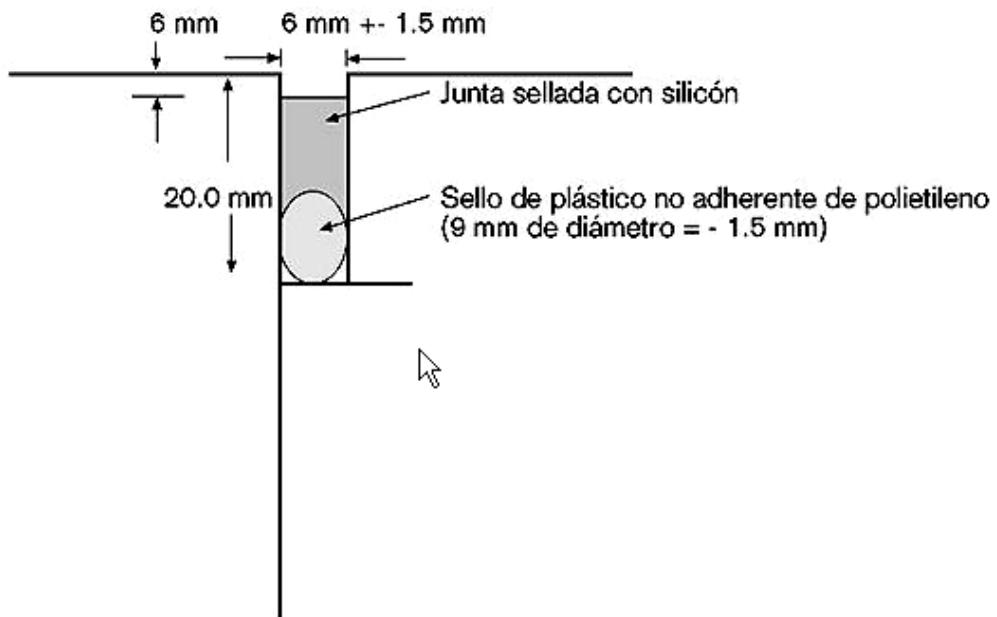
Corte y sellado de junta de contracción transversal de construcción (Con pasajuntas Tipo D).
